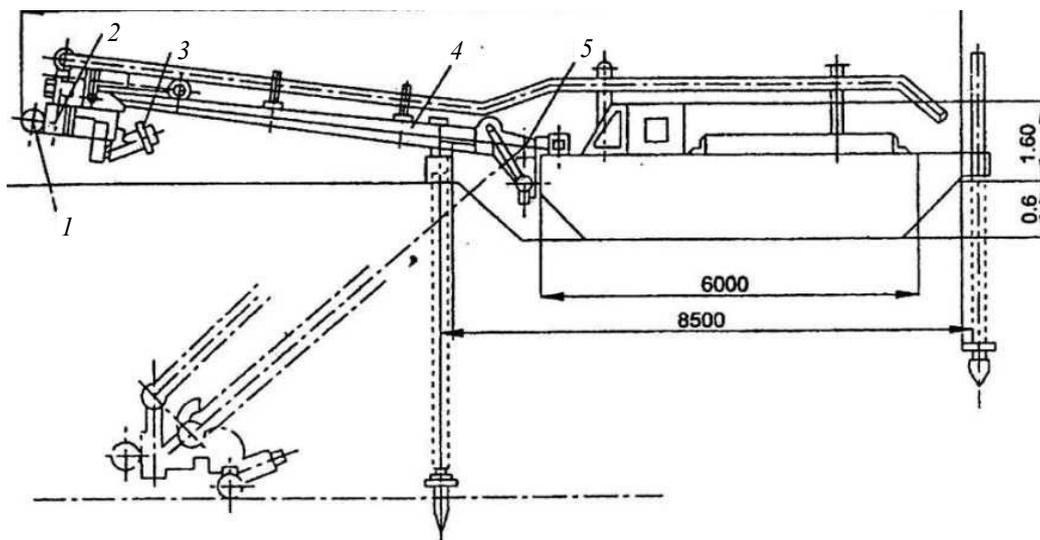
Землесос фирмы «Беното» (Франция): 1 – механический рыхлитель; 2 – грунтовой насос; 3 – гидрорыхлитель грунтового насоса; 4 – рама; 5 – гидроцилиндр подъема и опускания рамы
